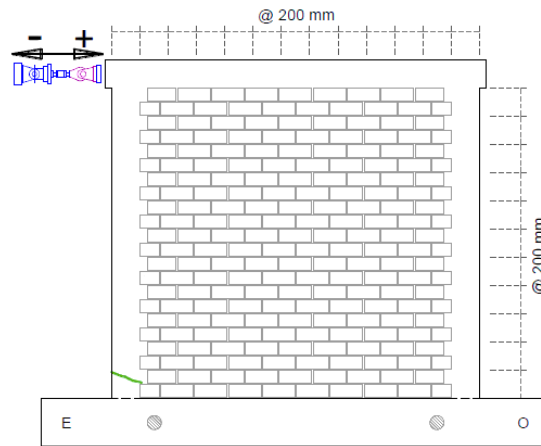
Aparición de la primera fisura en el muro confinado en la Fase 2 del ensayo [19]
